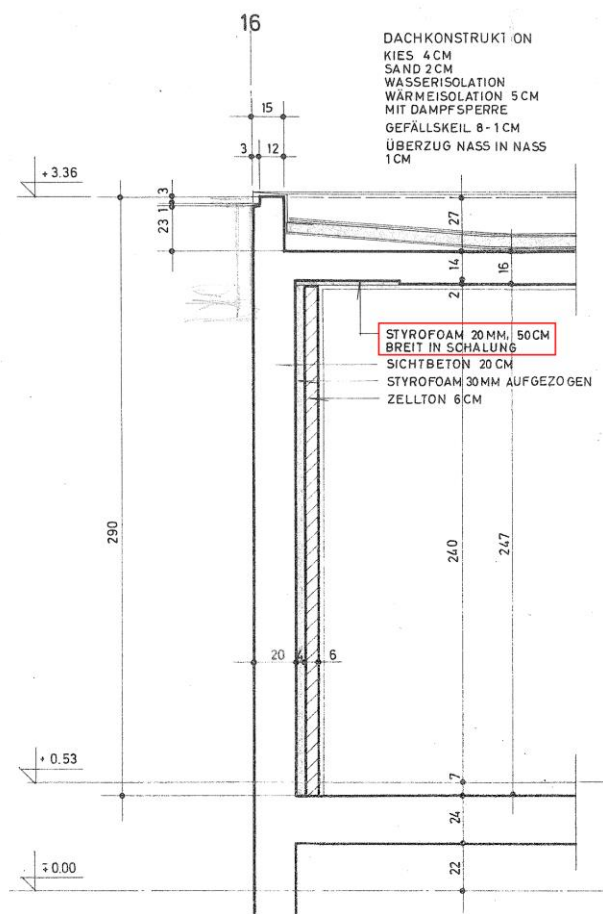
Schnitt durch Fassade mit eingelegter Styrofoamdämmung (Schnitt 111 aus Plan 147/119)
